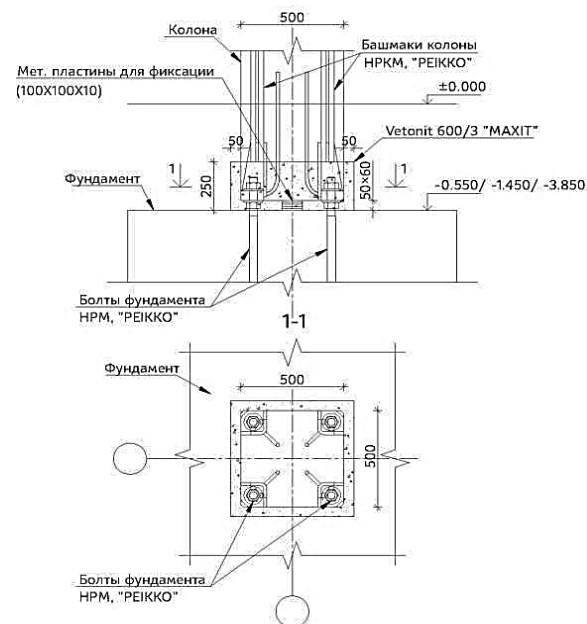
Примыкание прямоугольной колонны к ростверку фундамента ТЦ «Замок», г. Минск
